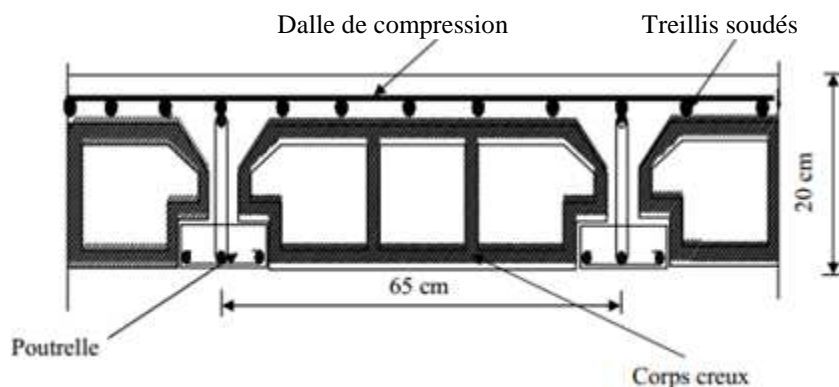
Coupe transversale d'un Plancher en corps creux.
